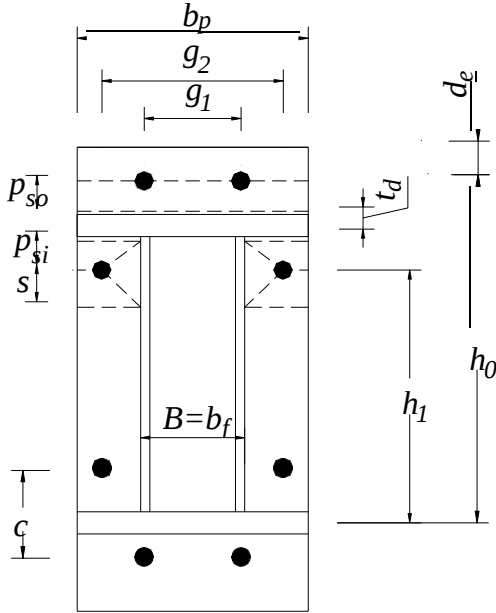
Patrón de línea de cedencia de plancha de extremo interna para conexión emperrada de 8 pernos rigidizada horizontalmente con plancha de cubierta
